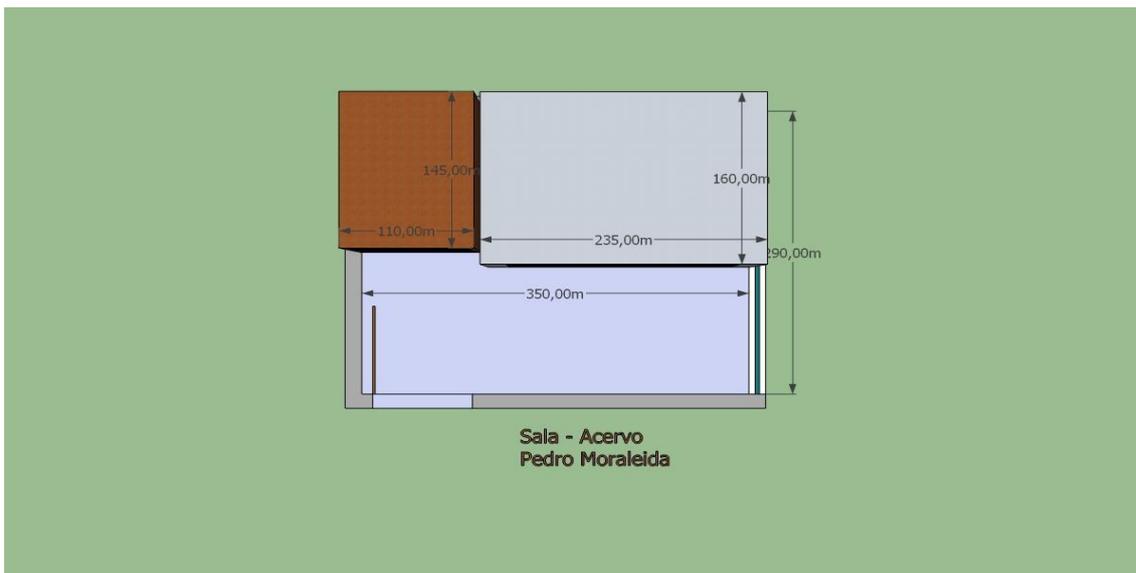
Planta do acervo. Elaboração: Vanessa Taveira
